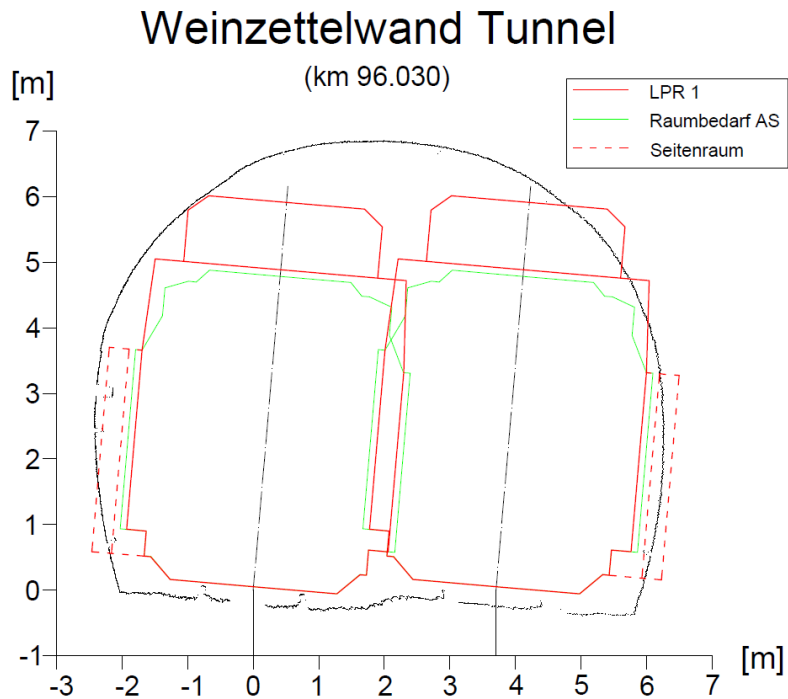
Tunnelprofil Weinzettelwand Tunnel [87]
